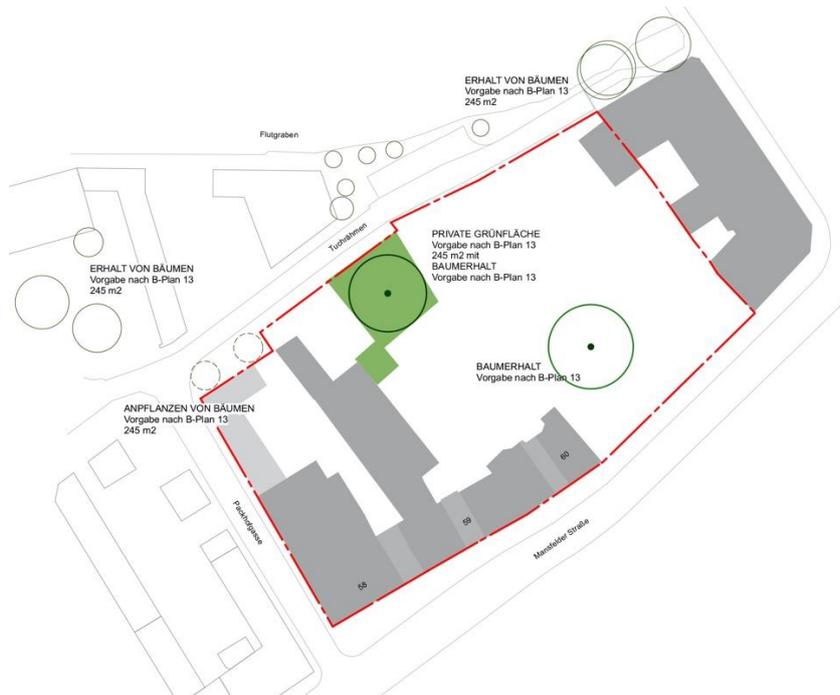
Grünflächen, B-Plan Nr.13, Festsetzung, (Grafik erstellt durch Büro Gehrhardt Landschaft)
